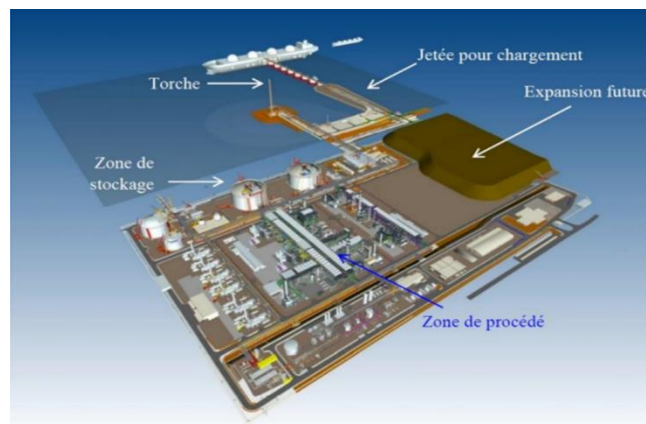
Maquette 3D vue d'ensemble de l'usine [3].
